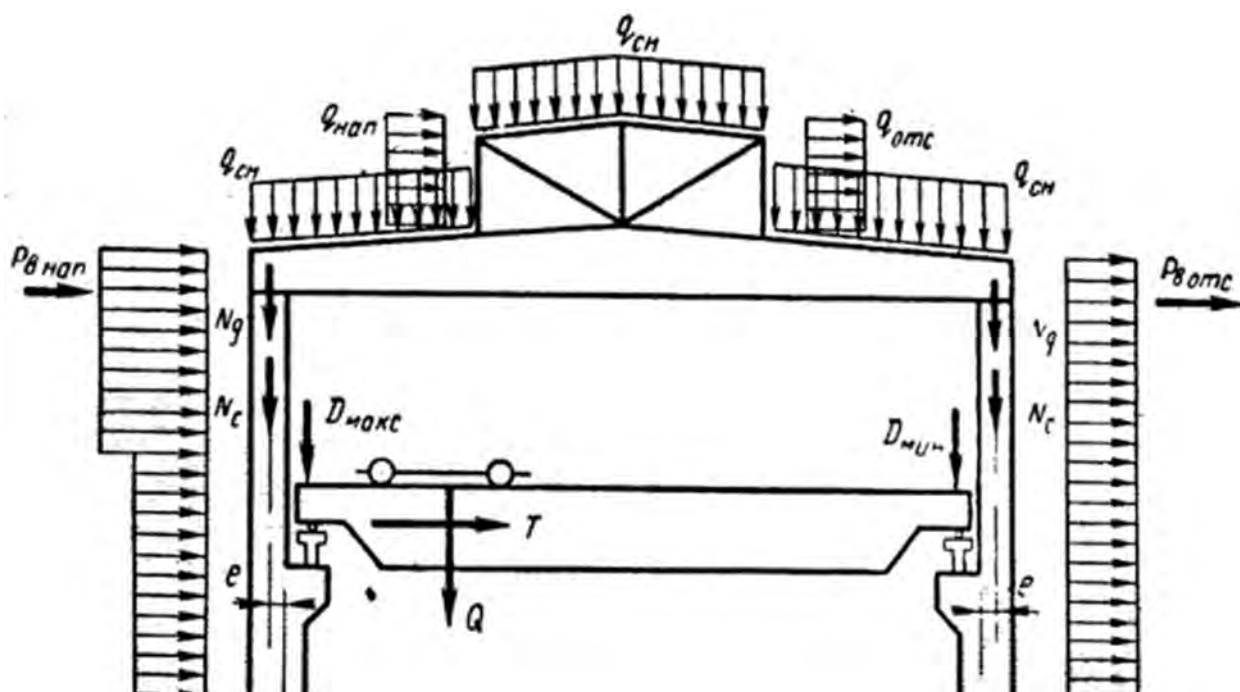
Расчетно-конструктивная схема поперечной рамы с нагрузками
